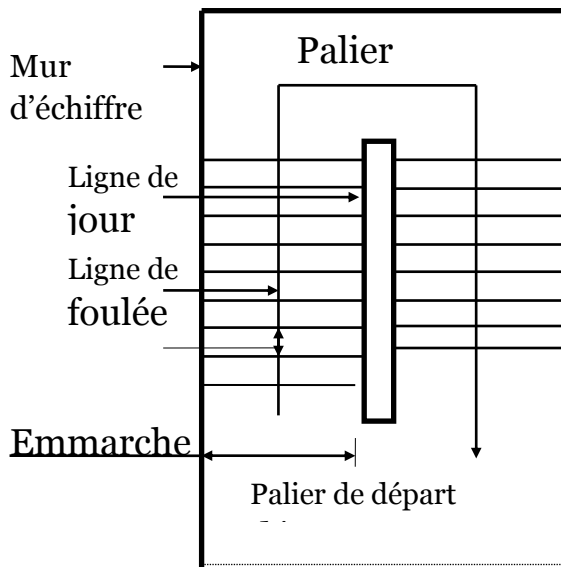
Vue en plan d'une cage d'escalier à paillasse adjacents
